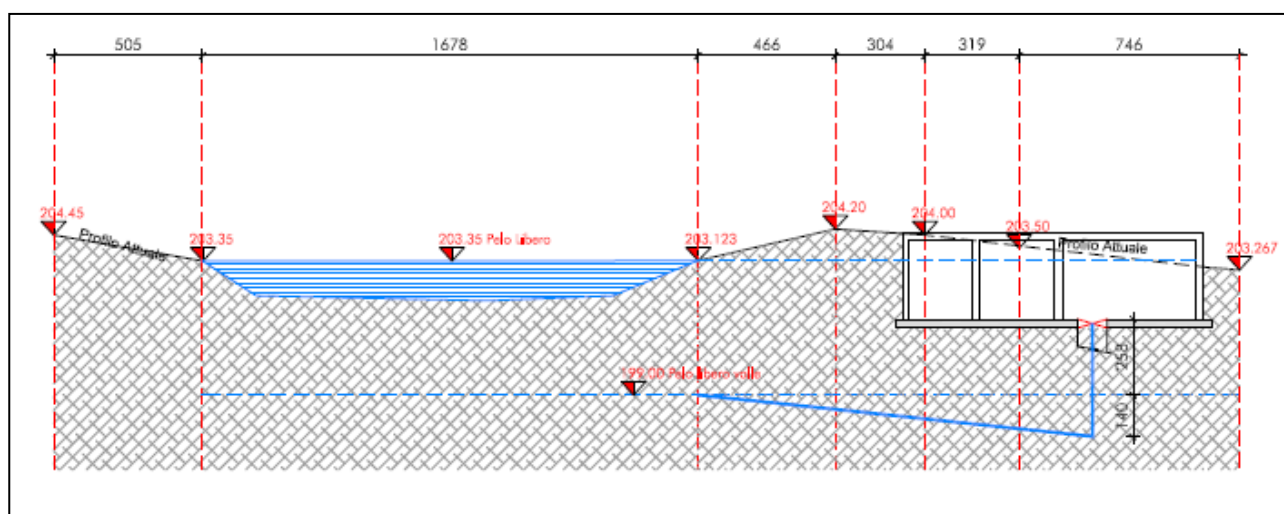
Sezione del locale centrale con vista a valle della briglia con il vano di alloggiamento della turbina e lo scarico di restituzione delle acque turbinate
